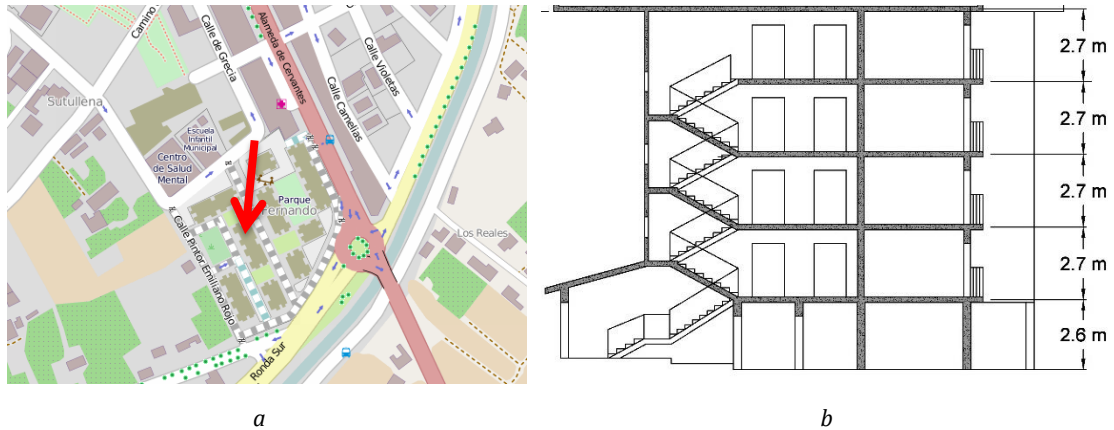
Edificio bloque 11 del barrio de San Fernando (Lorca). a) Ubicación del bloque 11, b) Sección lateral del alzado con detalle de la zona de gradas y áreas comunes (fuente: Ayuntamiento de Lorca).
